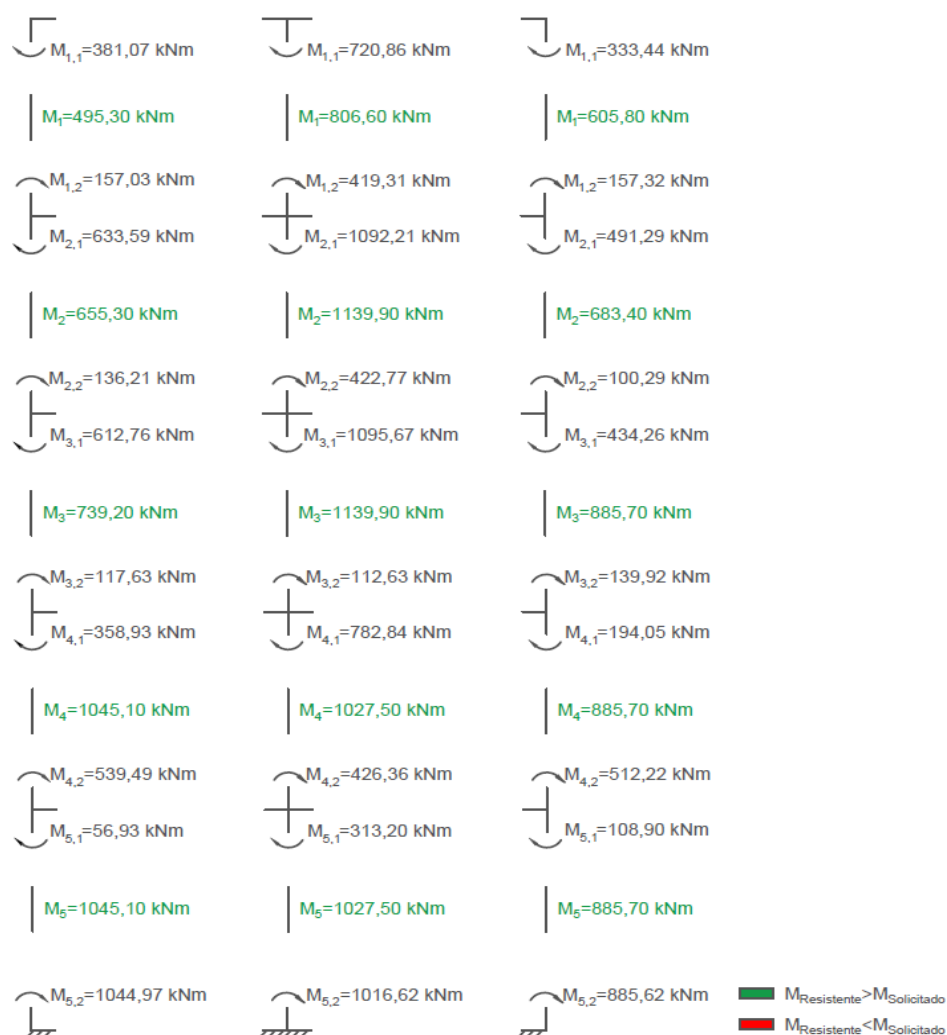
Análisis por planta del momento resistente y solicitado en cada pilar
